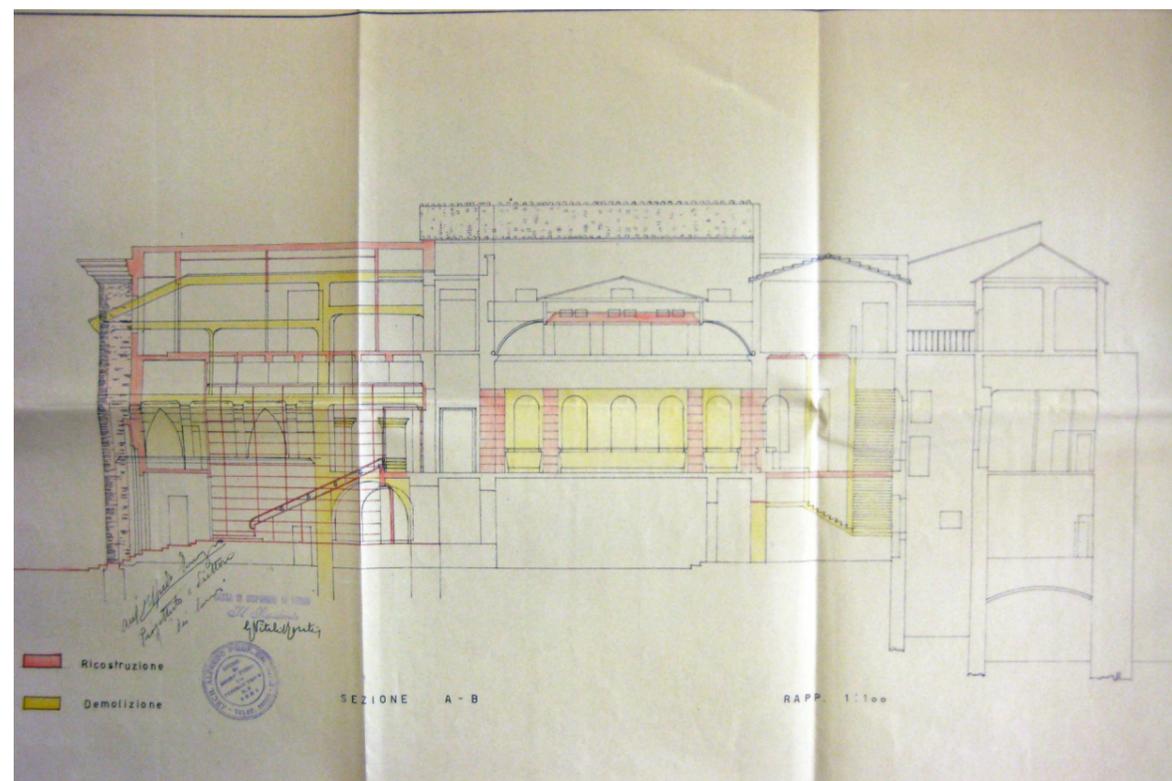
Sezione longitudinale. Progetto dell'architetto Alfredo Energici. Archivio della Cassa di Risparmio.
